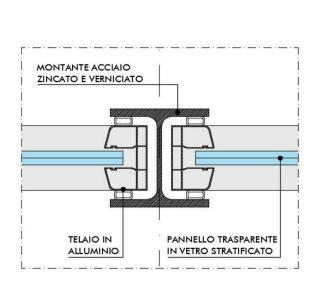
BARRIERA ACUSTICA MISTA FONOASSORBENTE-FONOISOLANTE SU RILEVATO –
